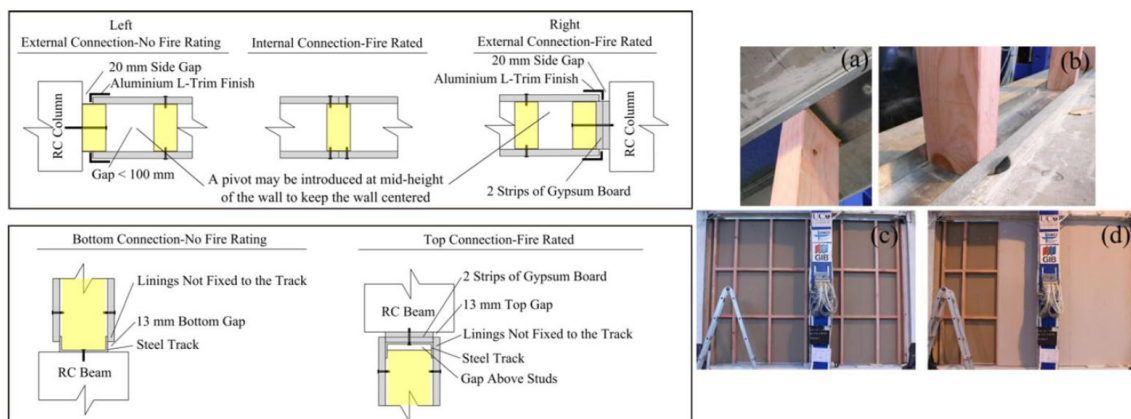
Detalhes de baixo dano adotado em paredes de gesso com estrutura em madeira. a) e b) montantes ajustados por fricção nos trilhos de aço, c) sistema de estrutura completa após a colocação do revestimento de gesso em um dos lados, d) revestimentos fixados a parede. Adaptado de [27]
